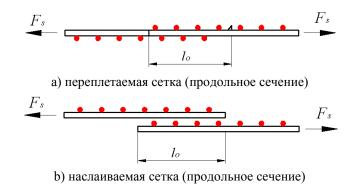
Соединения внахлестку сварных сеток
